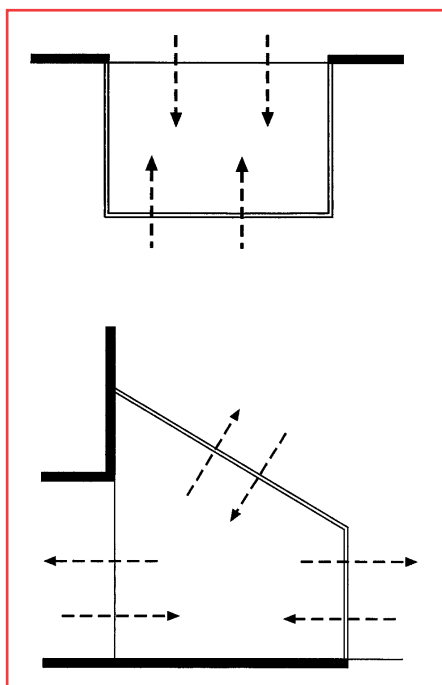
Schnitt durch einen Wintergarten: Wärmeströme zwischen Kernhaus, Glashaus und Außenbereich
